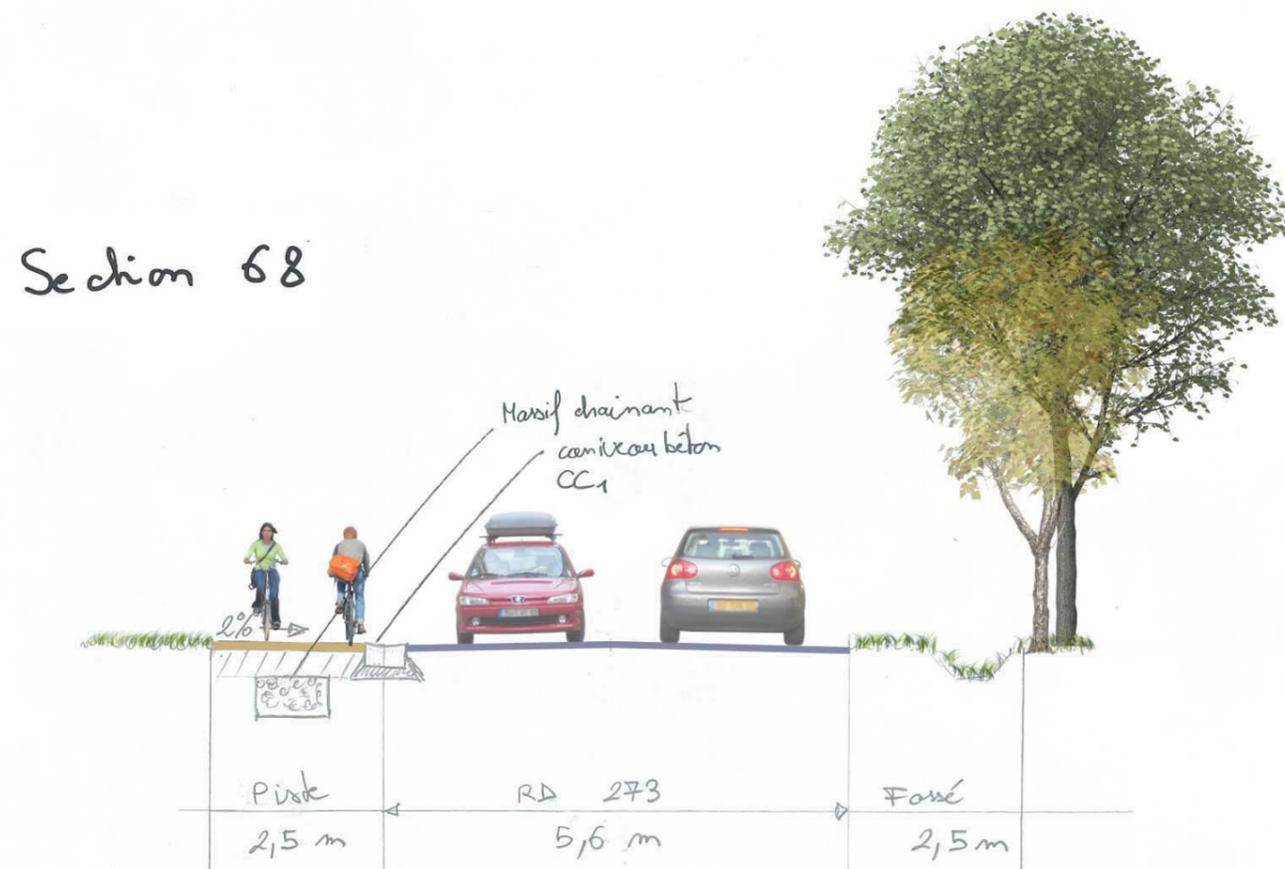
VUE EN COUPE D'UNE PISTE EN SITE PROPRE (SOURCE : SCE)
